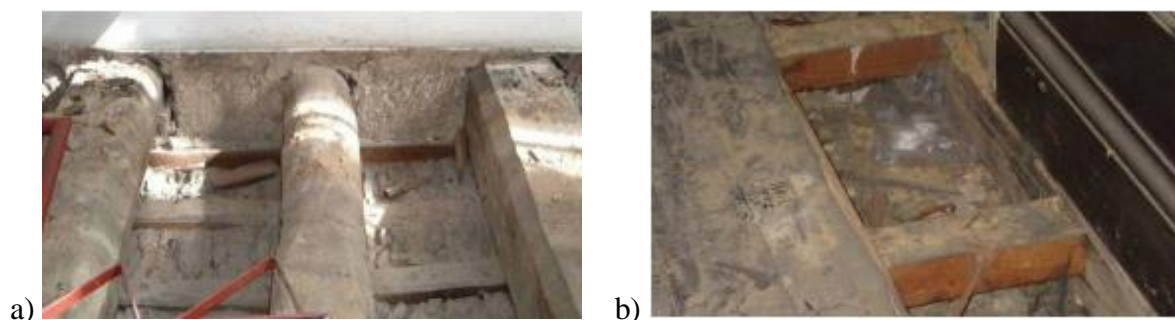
Apoio do vigamento em paredes: a) vigas encastradas em paredes de alvenaria. Edifício do Largo São Domingues, Porto (Ilharco, 2008); b) Viga apoiadas em frechal. Edifício do Largo dos Lóios, Porto (Ilharco, 2008).
